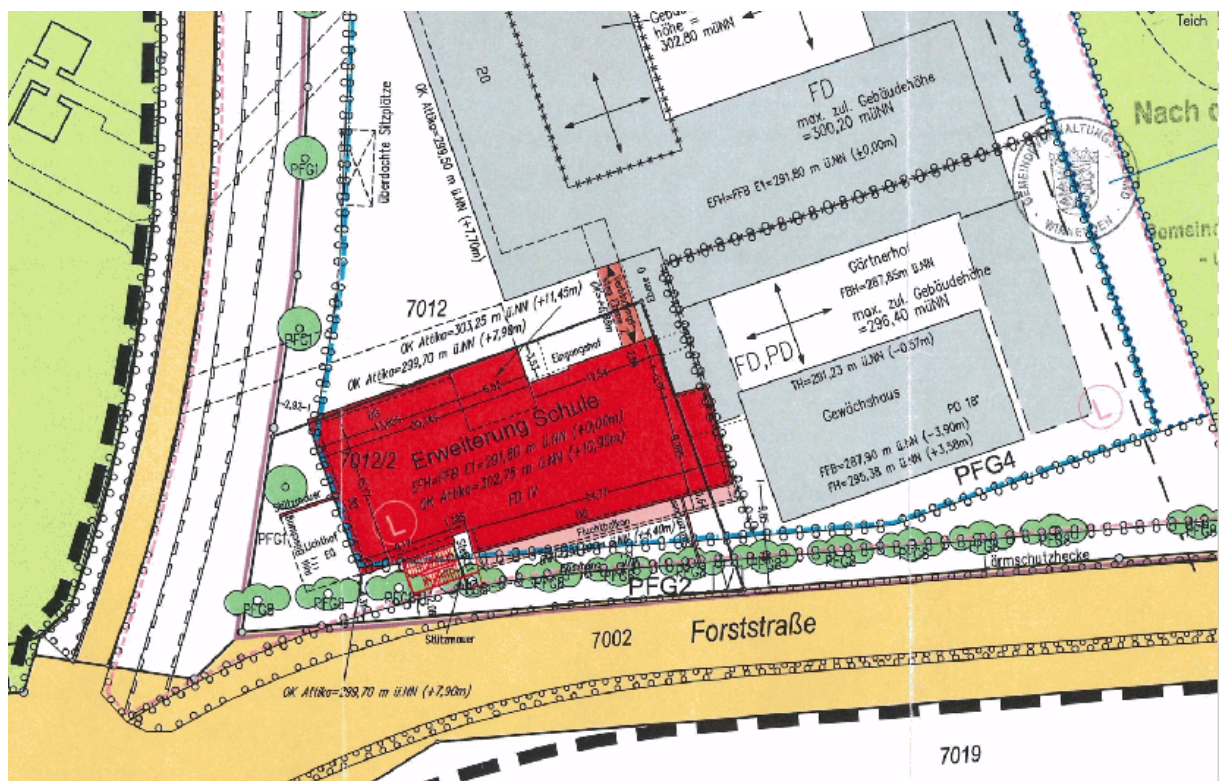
Lageplan „Erweiterung Schule“ sowie bestehendes „Gewächshaus“
